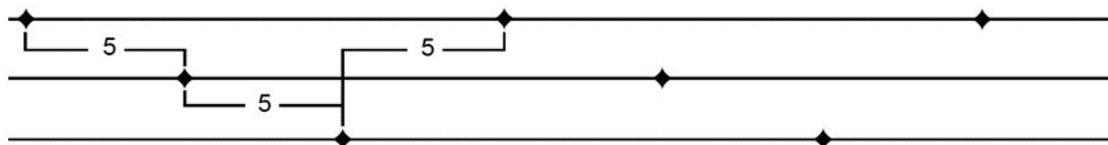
Размещение на проводах 3-х фазных ВЛ.
